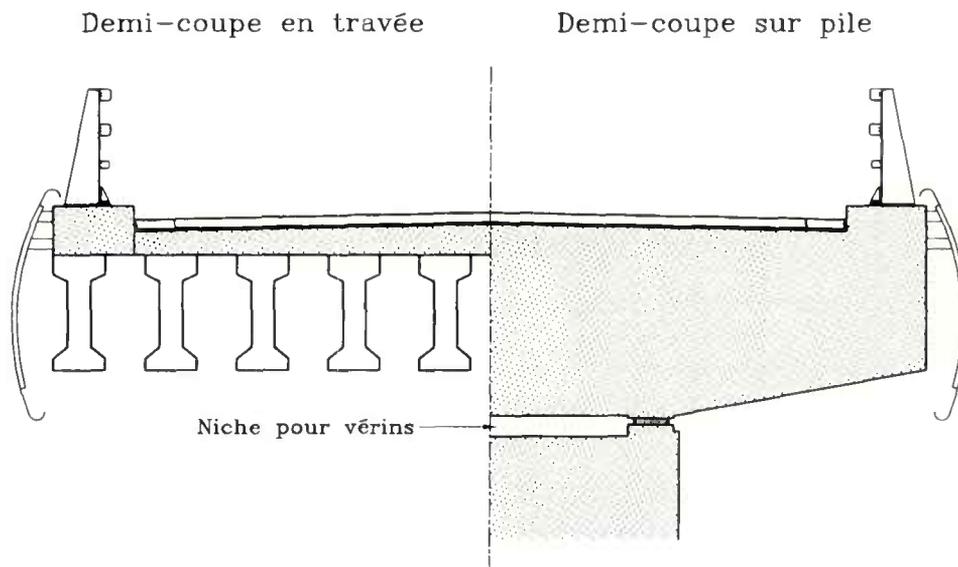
Suppression du sommier d'appui dans le cas des poutres rendues continues.
